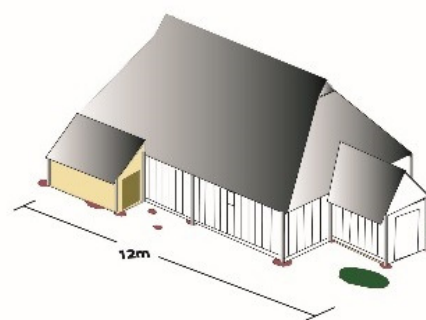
Double file de poteaux porteurs pour un plancher de grenier. Maison-étable avec stabulation au rez-de-chaussée et grange à l'étage. Crandelles, Cantal.
